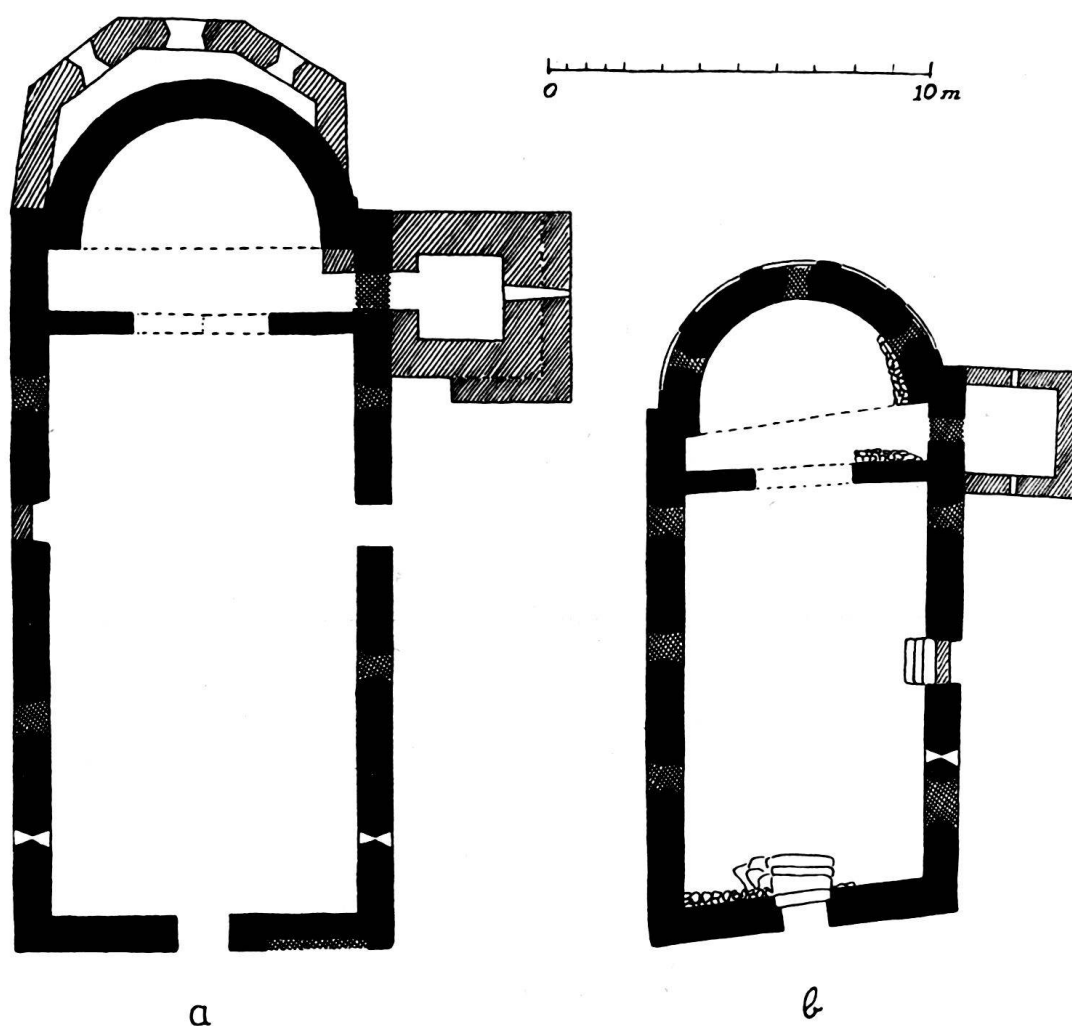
Einschiffige Pfarrkirchen: a) Scherzligen, b) Einigen.
